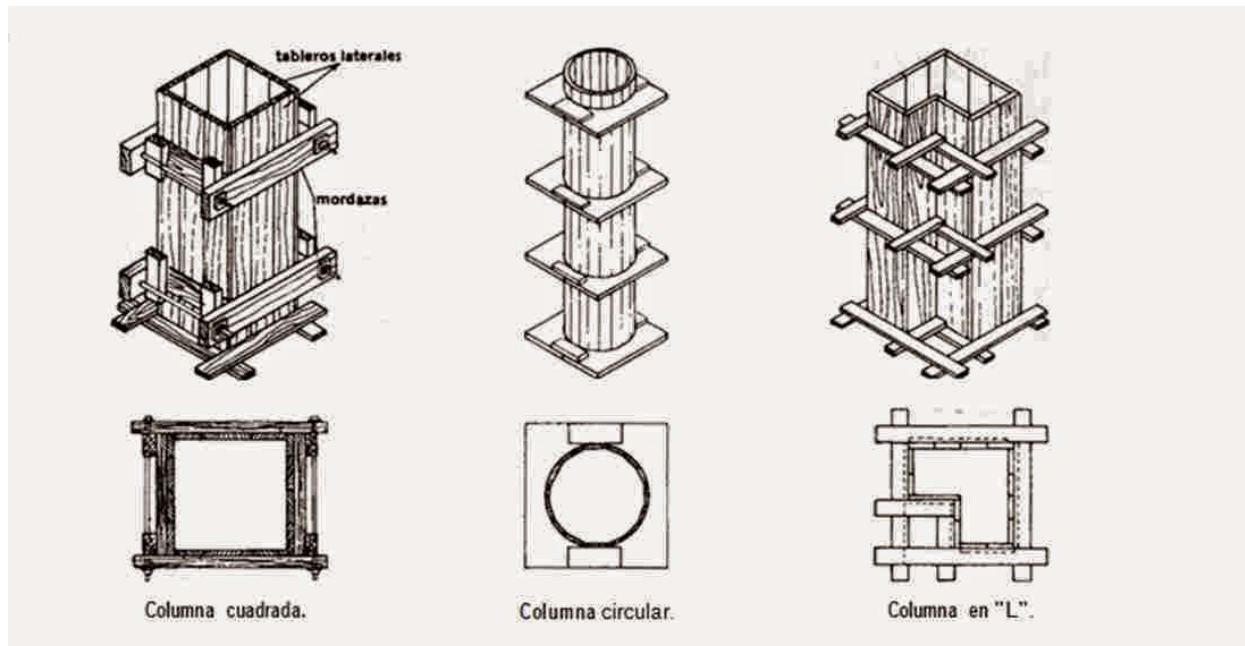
Cimbra para distintos tipos de áreas transversales en columnas.
